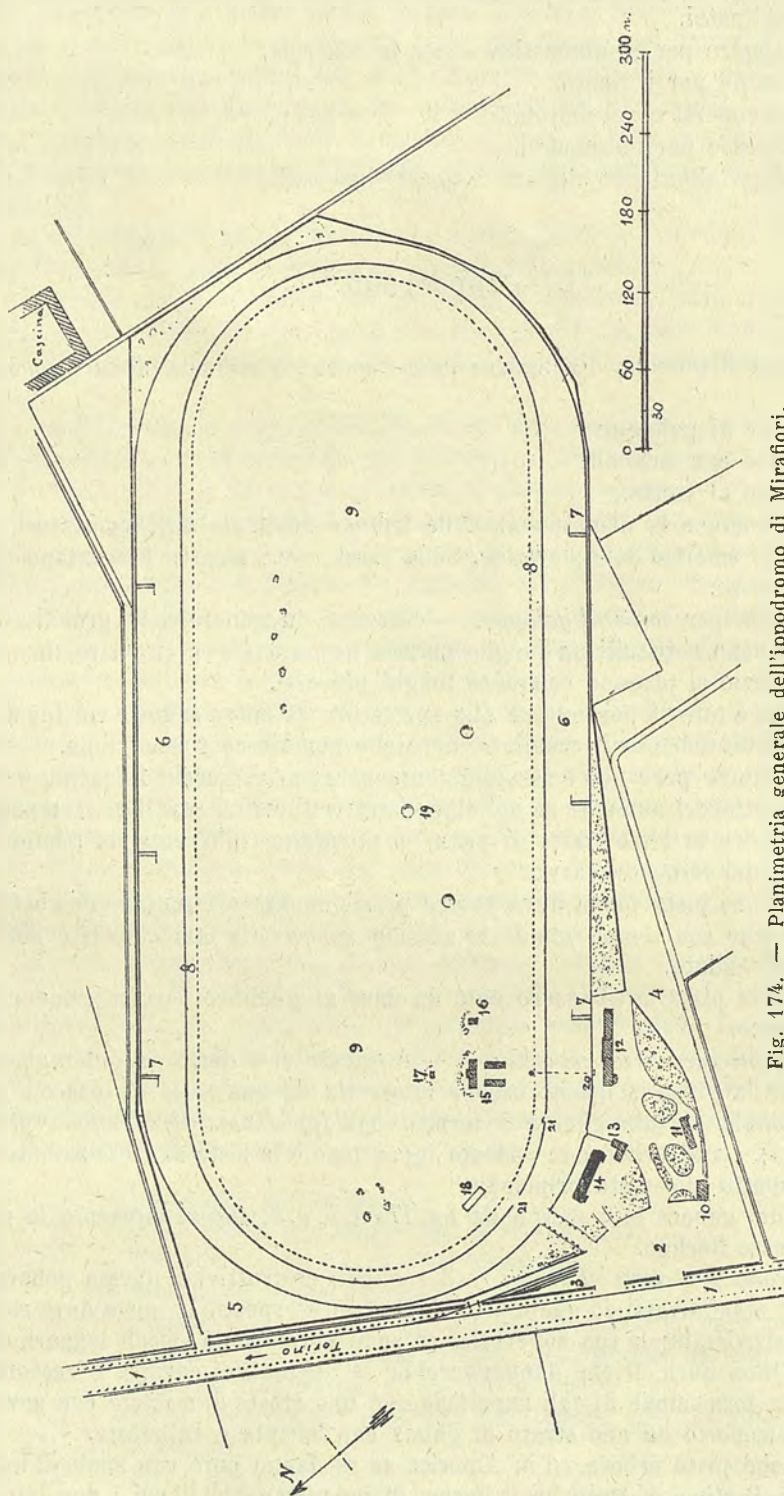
Planimetria generale dell'ippodromo di Mirafiori.
